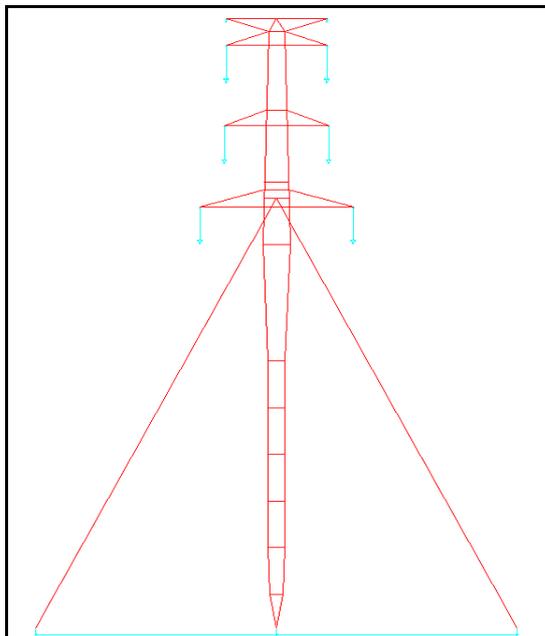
Silhuetas típicas das estruturas estaiadas que serão utilizadas na construção da LT500 kV Manaus - Boa Vista e Subestações Associadas
